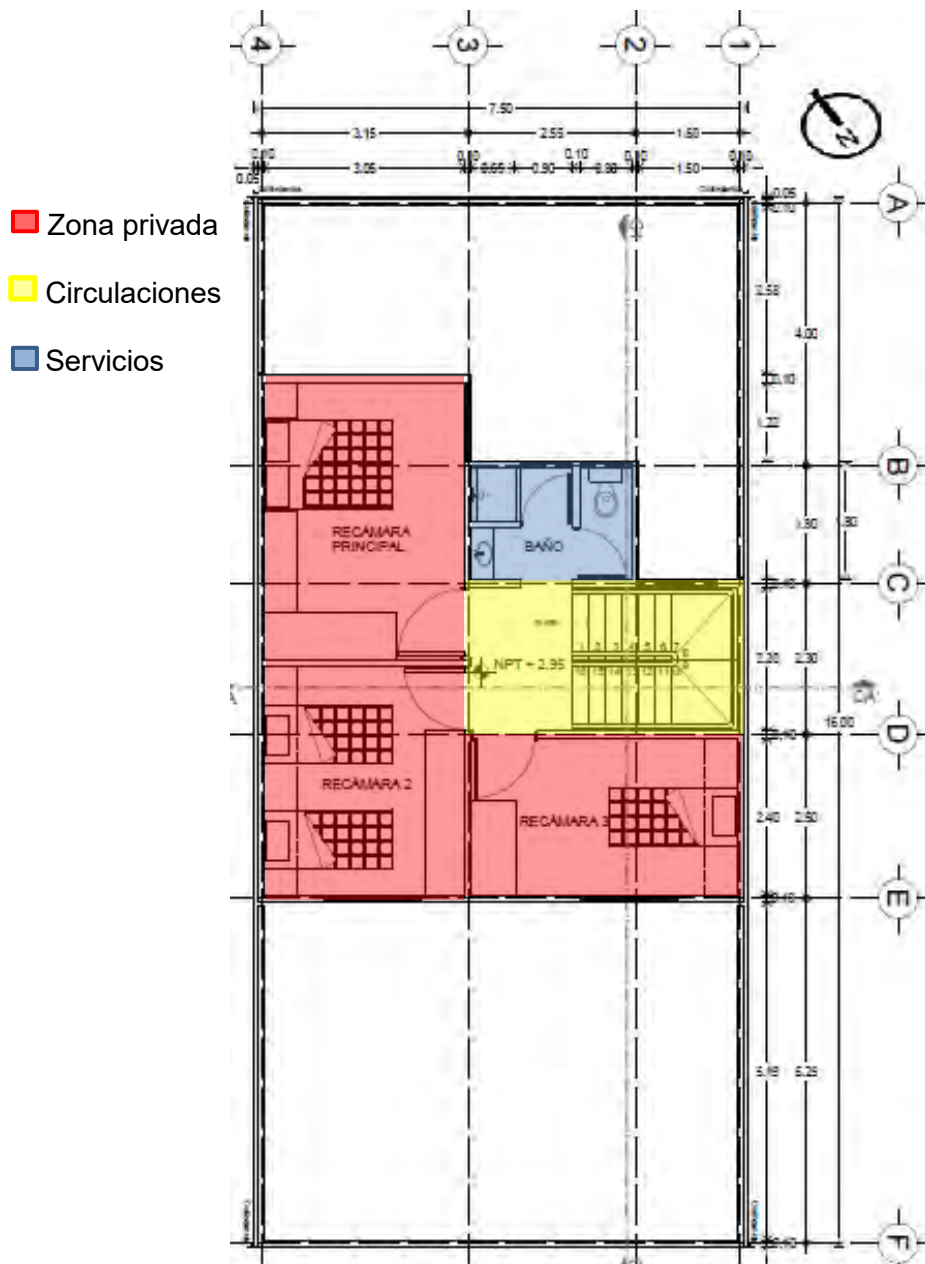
Planta arquitectónica de prototipo de vivienda B1. Tercera etapa, planta alta.
